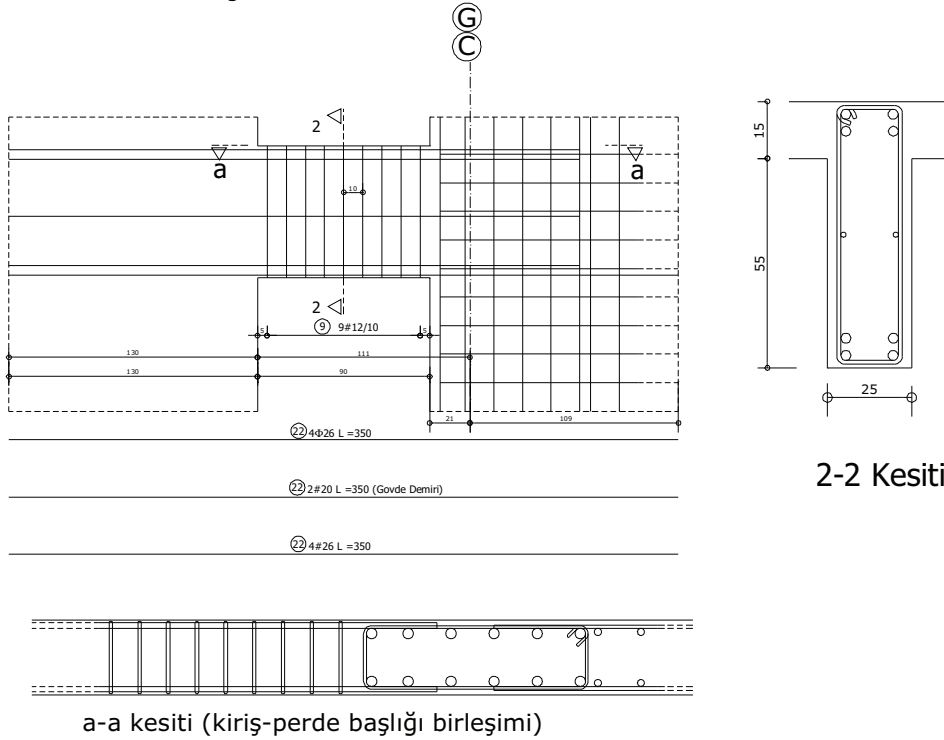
Perde donatı detayı; kesitleri ve plan
